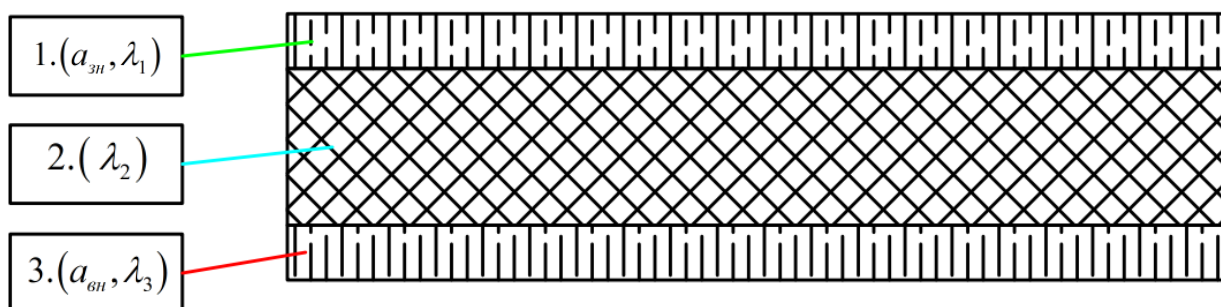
Поперечний розріз верхнього перекриття
